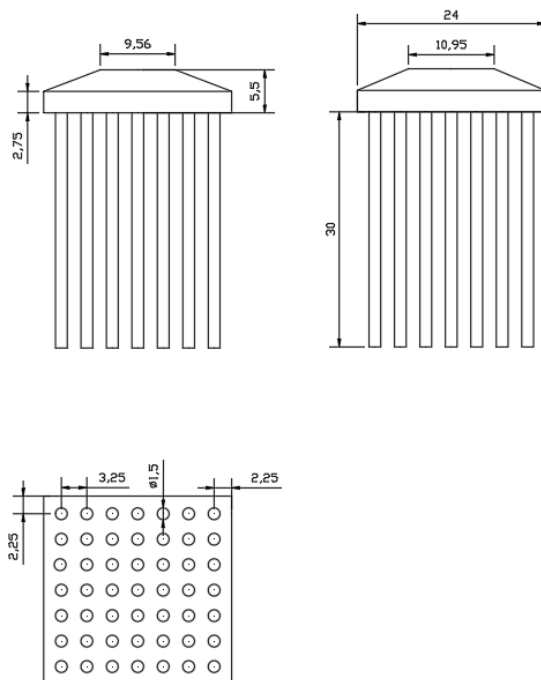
cimentación Pila 1 Alzado, planta y perfil
